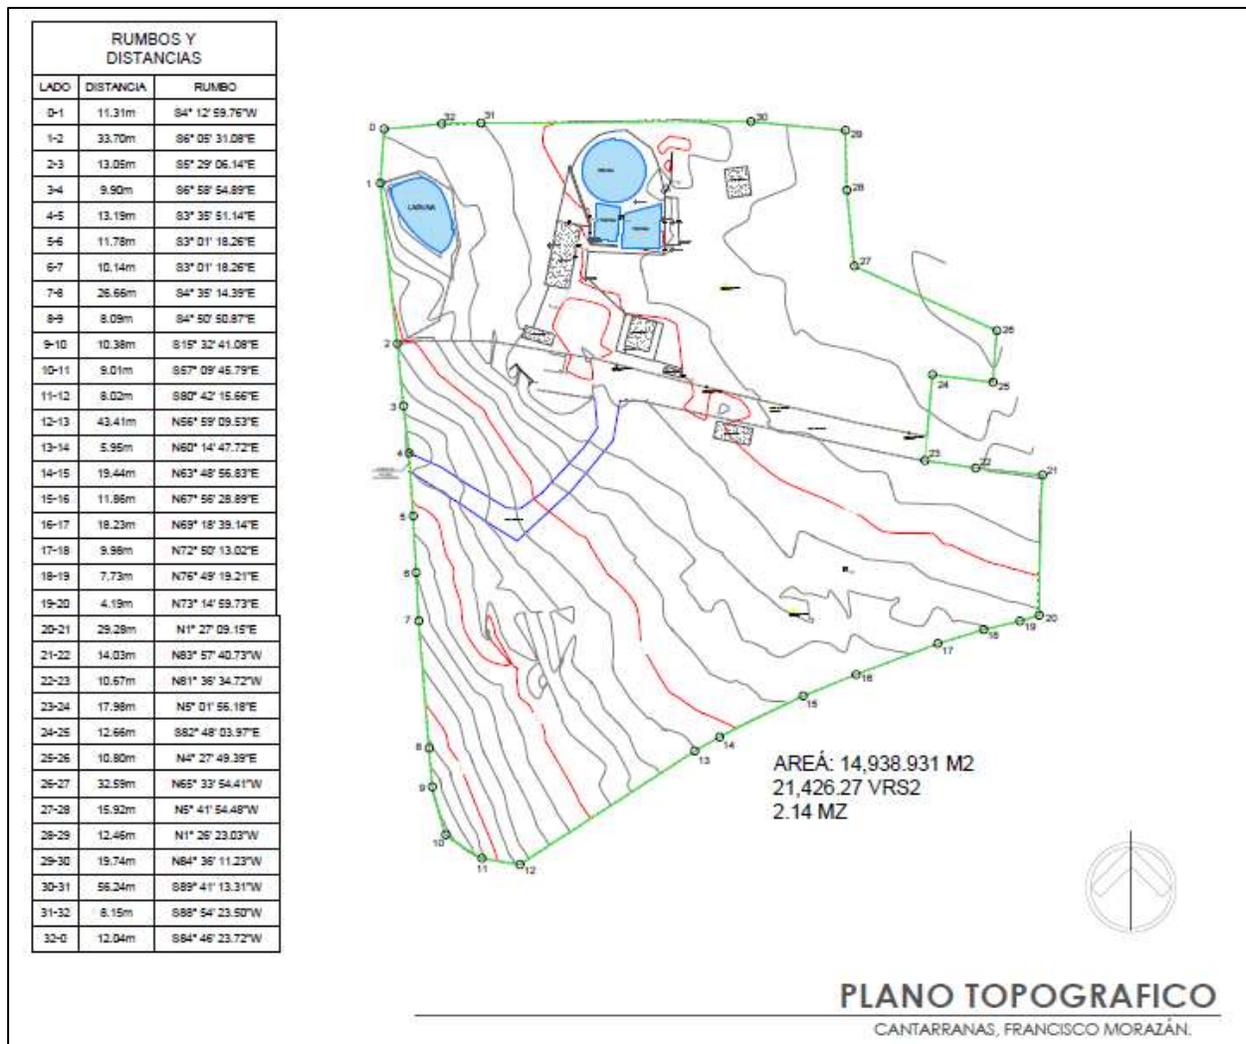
Levantamiento topográfico del terreno a construir la planta purificadora.
